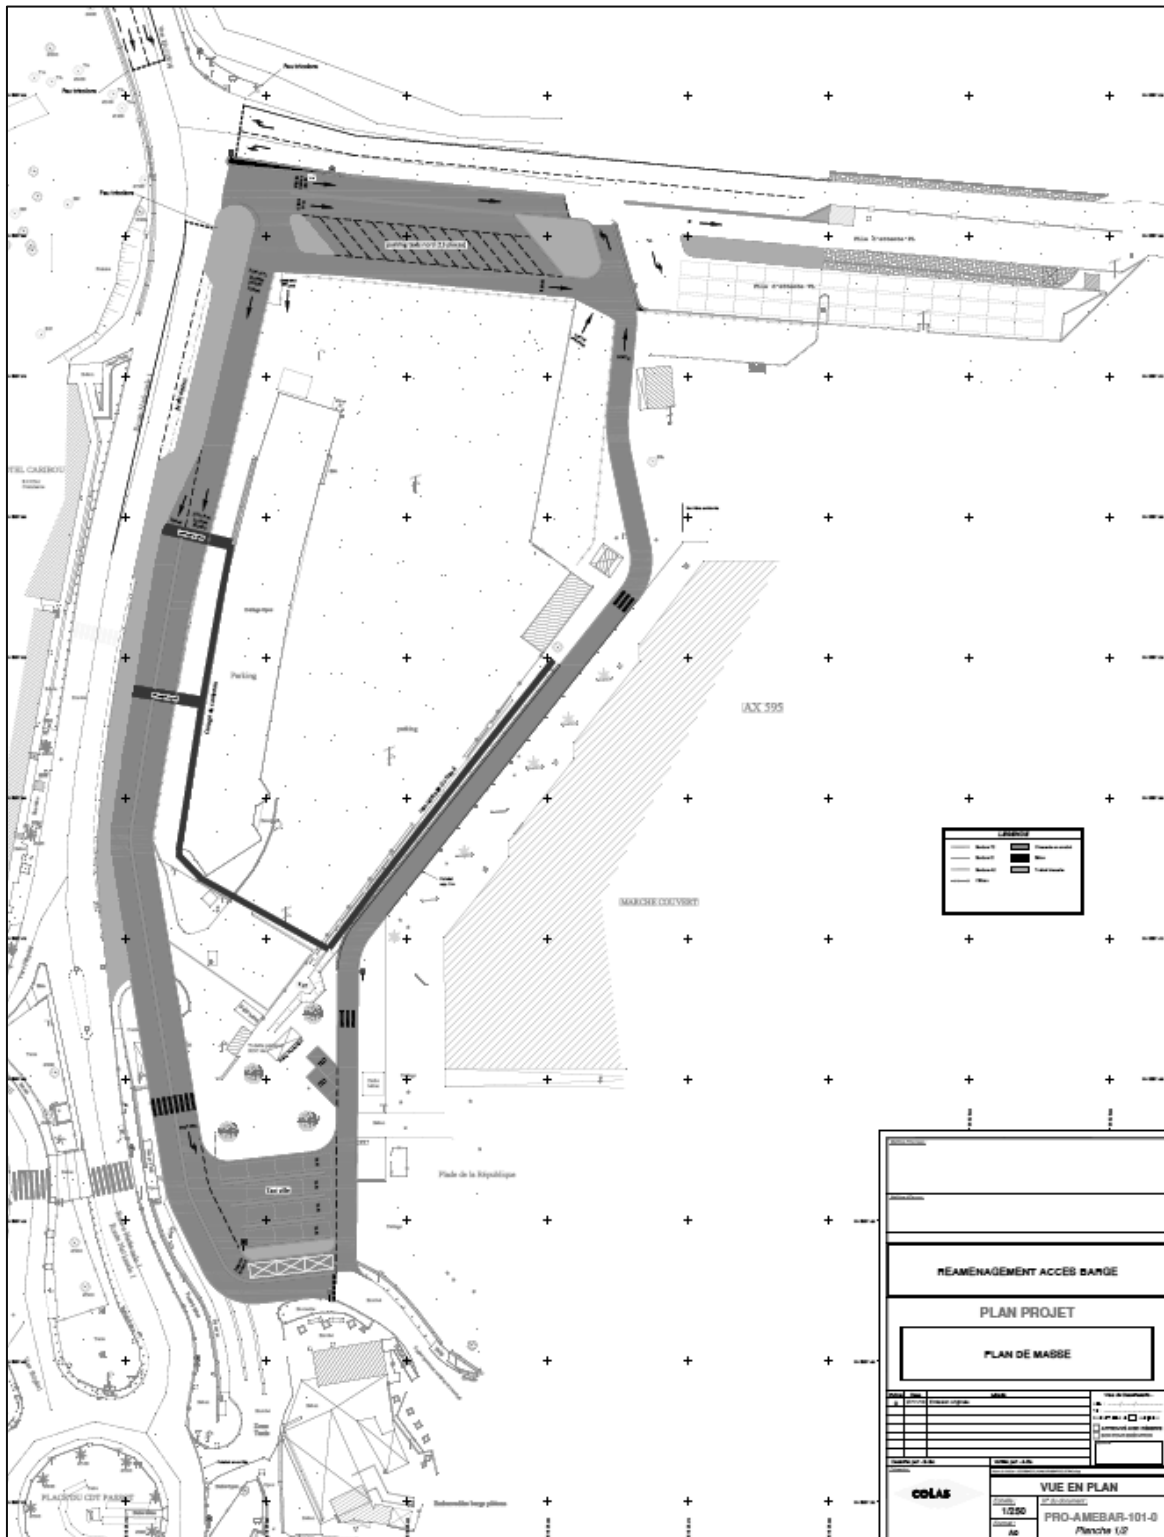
Plan masse du projet de réaménagement accès barges, extrait plan EXE de Colas
